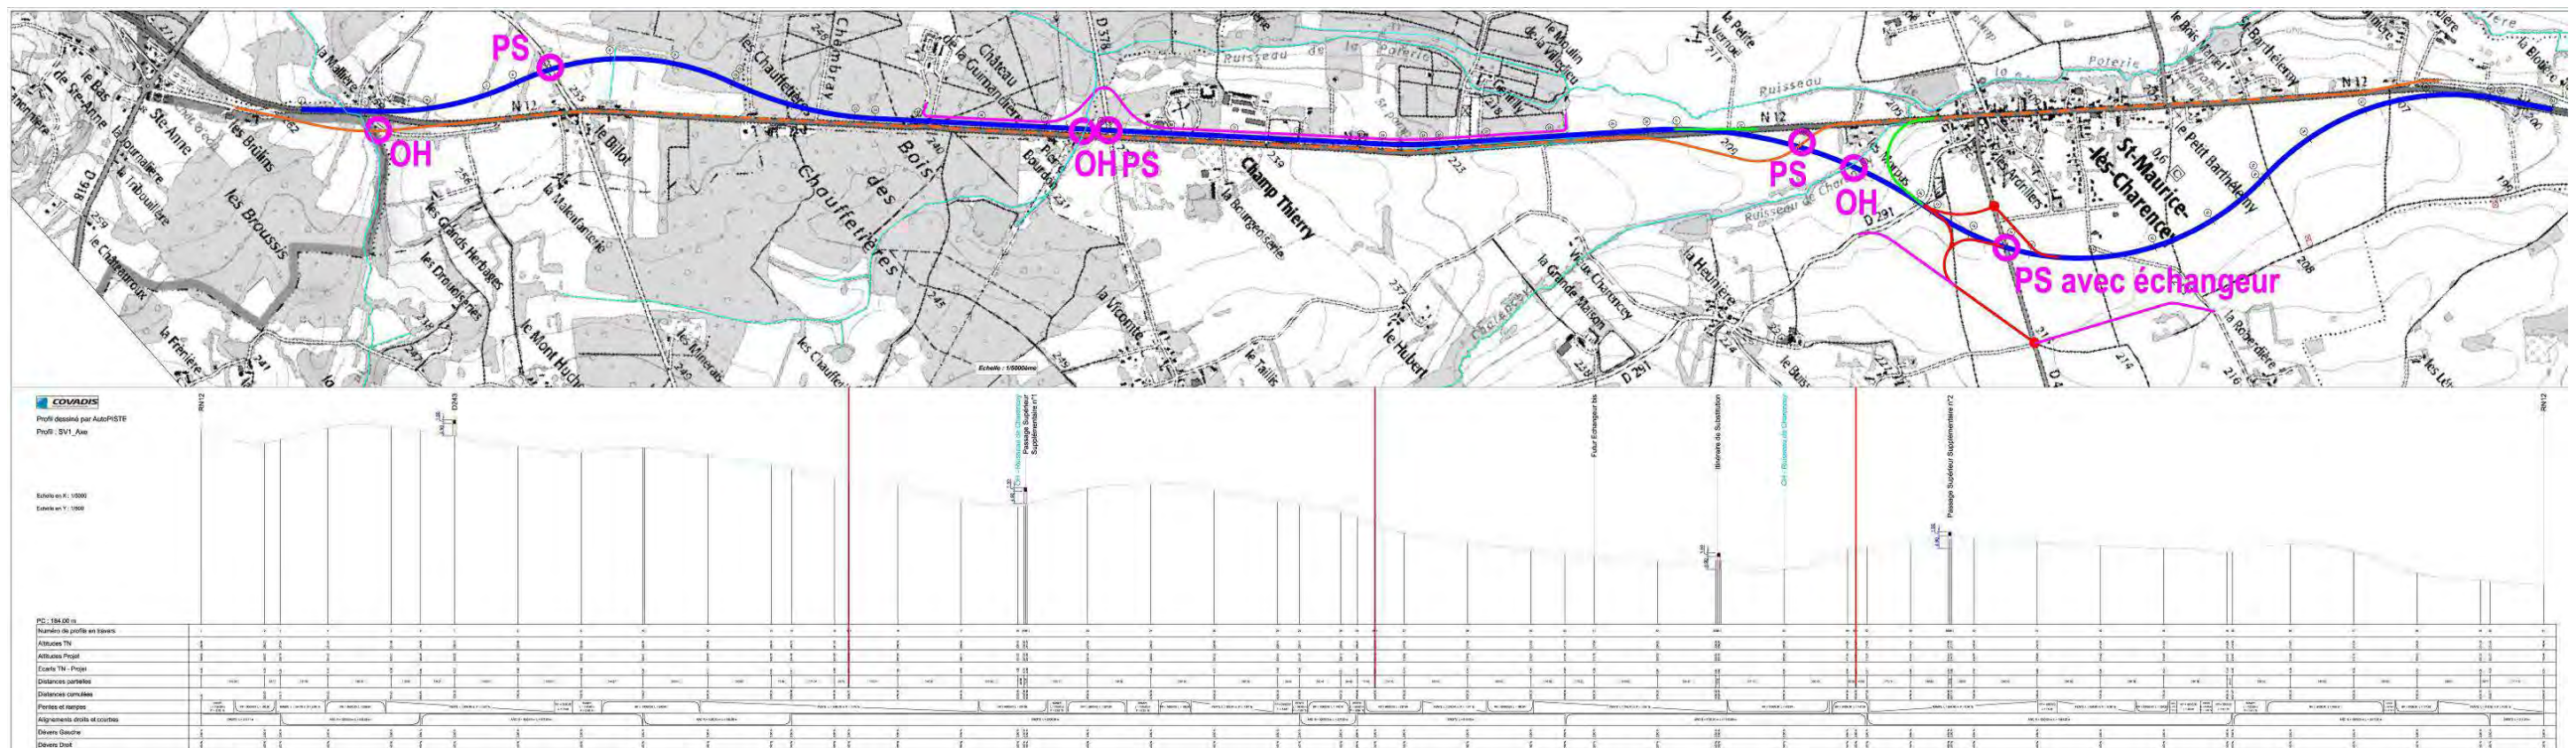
Tracé en plan et profil en long de la variante 1 (source : IGN / SEGIC)
